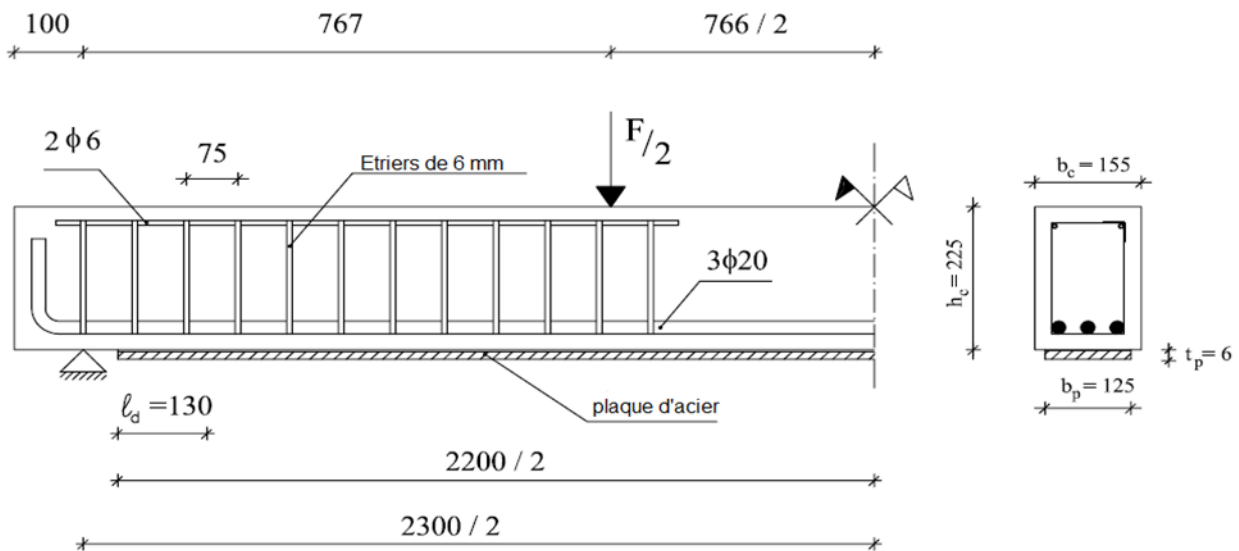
Poutre BA renforcé par une plaque d'acier – Dimensions en (mm) - (Roberts KTM)
